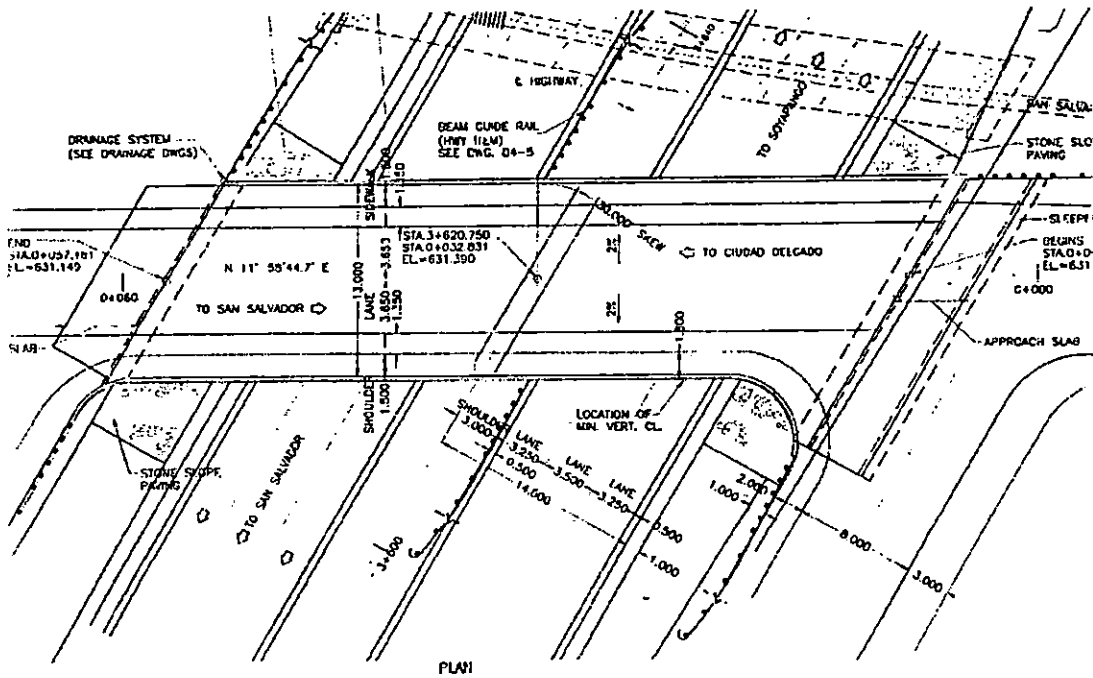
VISTA EN PLANTA DEL PUENTE JUAN BERTIS.
